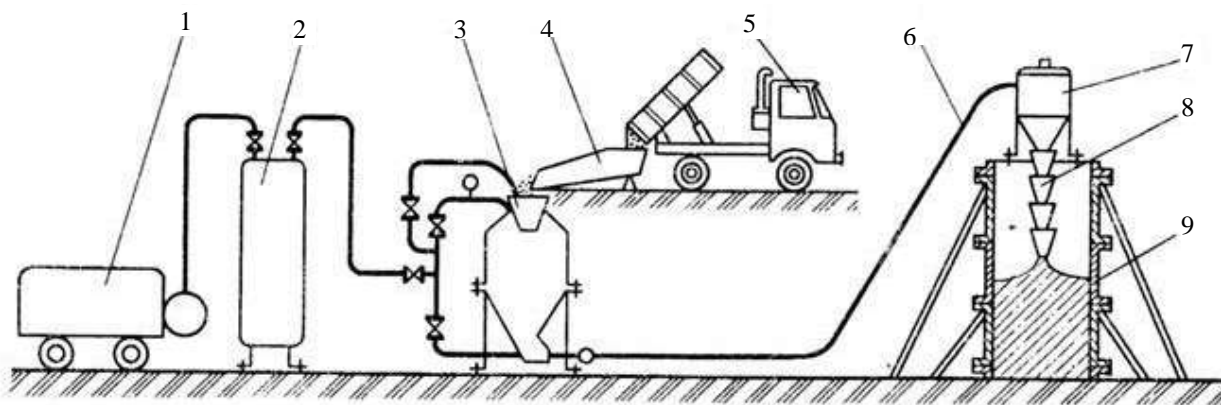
Схема бетонування за допомогою пневматичного нагнітача: 1 – компресор; 2 – ресивер; 3 – пневматичний нагнітач; 4 – віброживильник; 5 – автобетоновоз; 6 – бетоновод; 7 – гасник; 8 – хобот; 9 – опалубка
